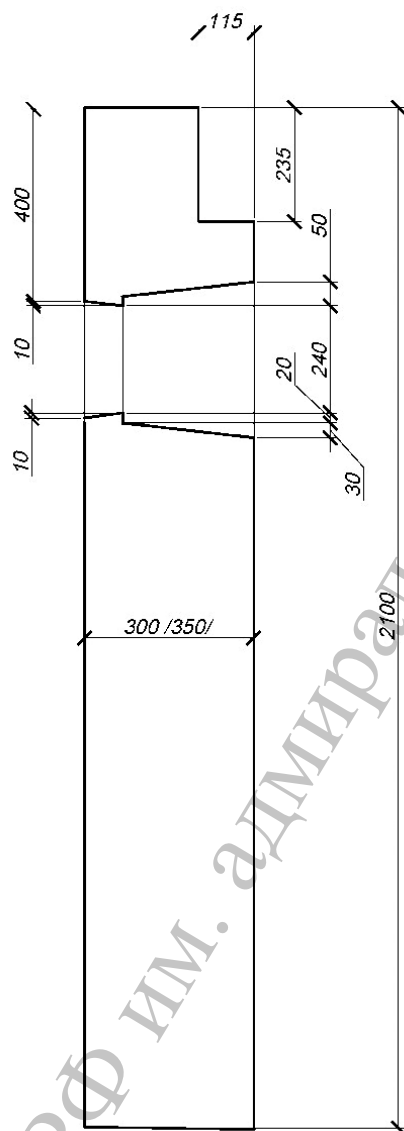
Наружная стеновая панель нулевого цикла 1ПСЦ 30.21.3.0.
